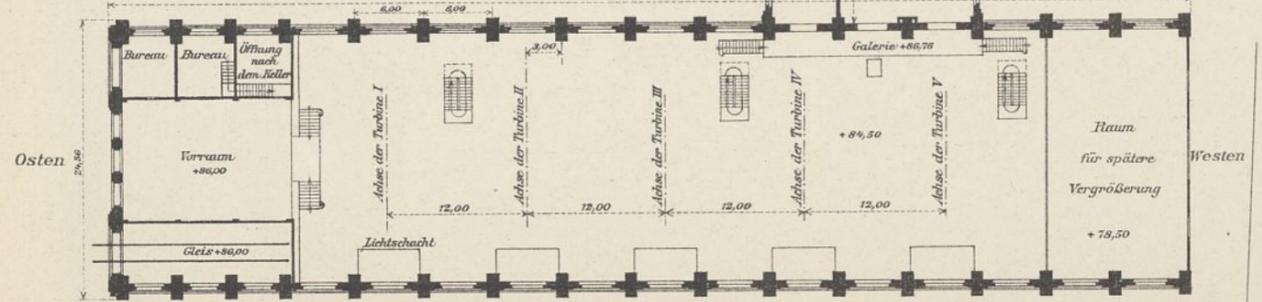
Maschinenhaus. Erdgeschoß. 1: 600.
